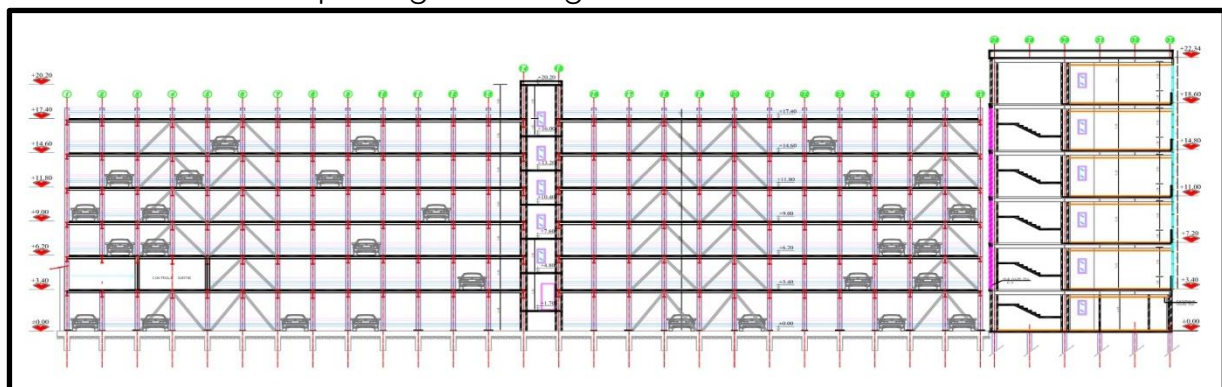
Coupe verticale de la construction [Autodesk AutoCAD – Bureau d'études]
